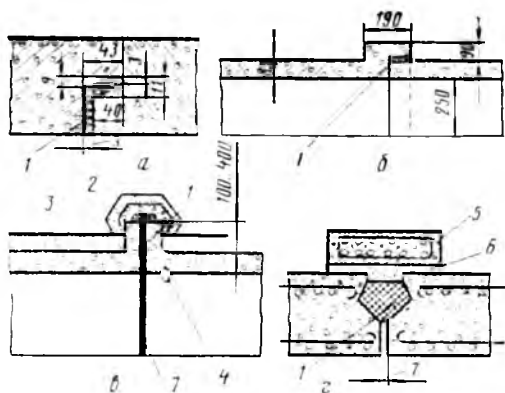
Конструкции соединений бетонных и железобетонных труб:
